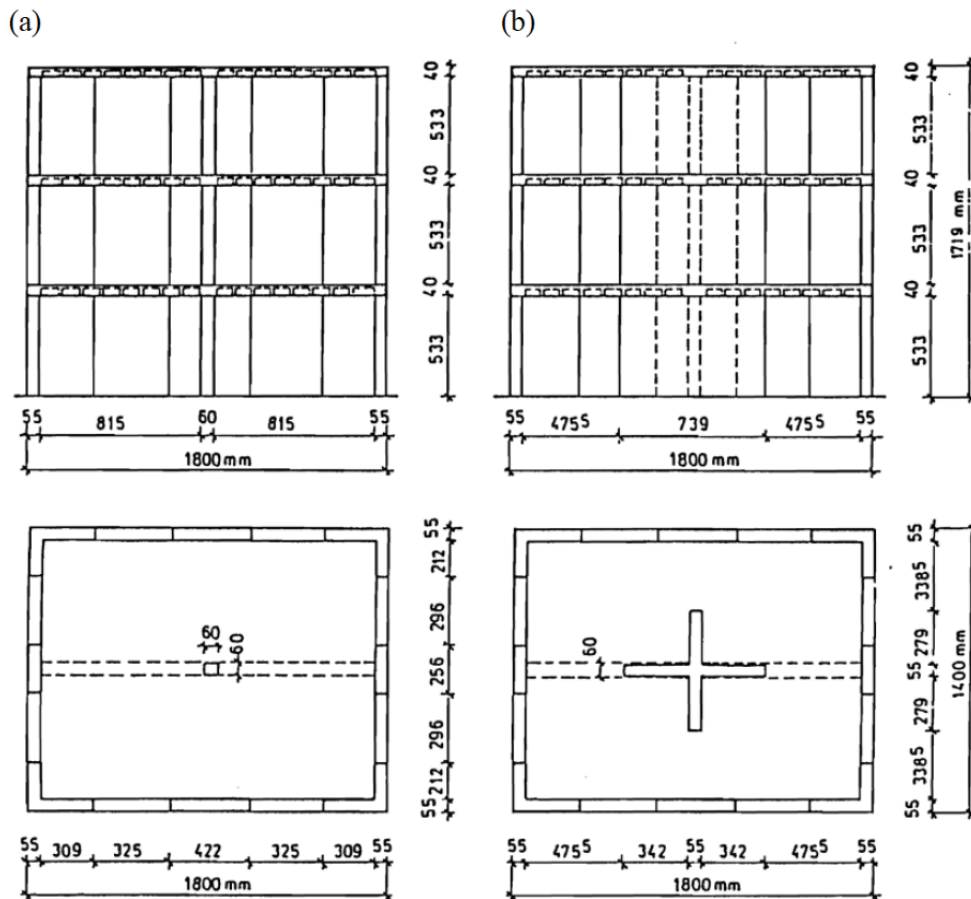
Pianta del piano terra e dei piani superiori del modello oggetto di sperimentazione da Tomazevic, 1990: a) modello con pilastro centrale, b) modello in muratura non rinforzata
